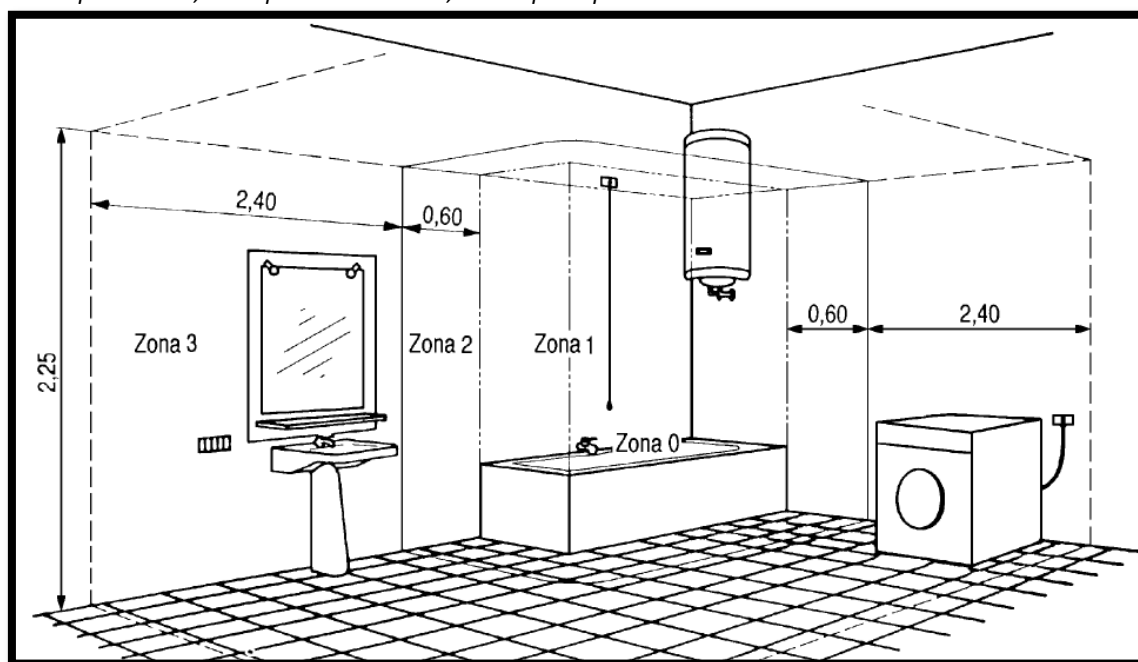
Zone di rispetto locale servizi con vasca da bagno (VB).
